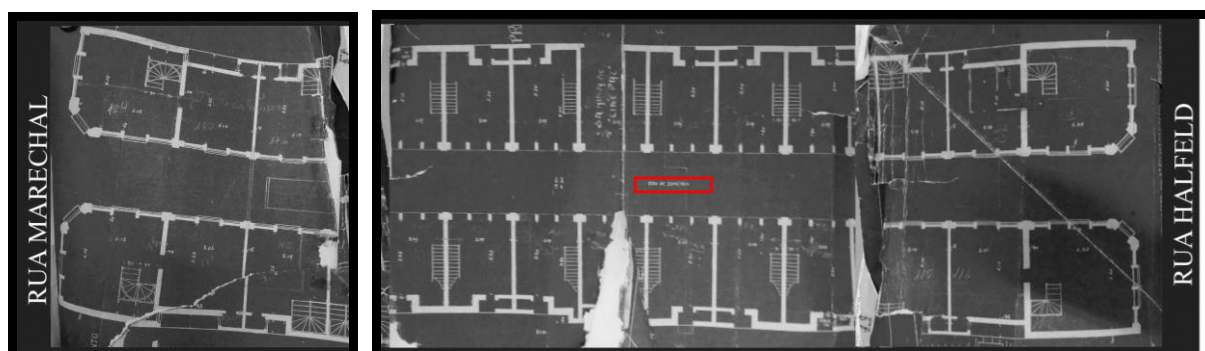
Planta 1º Pavimento Galeria Pio X com passagem para o Cine-Paz
